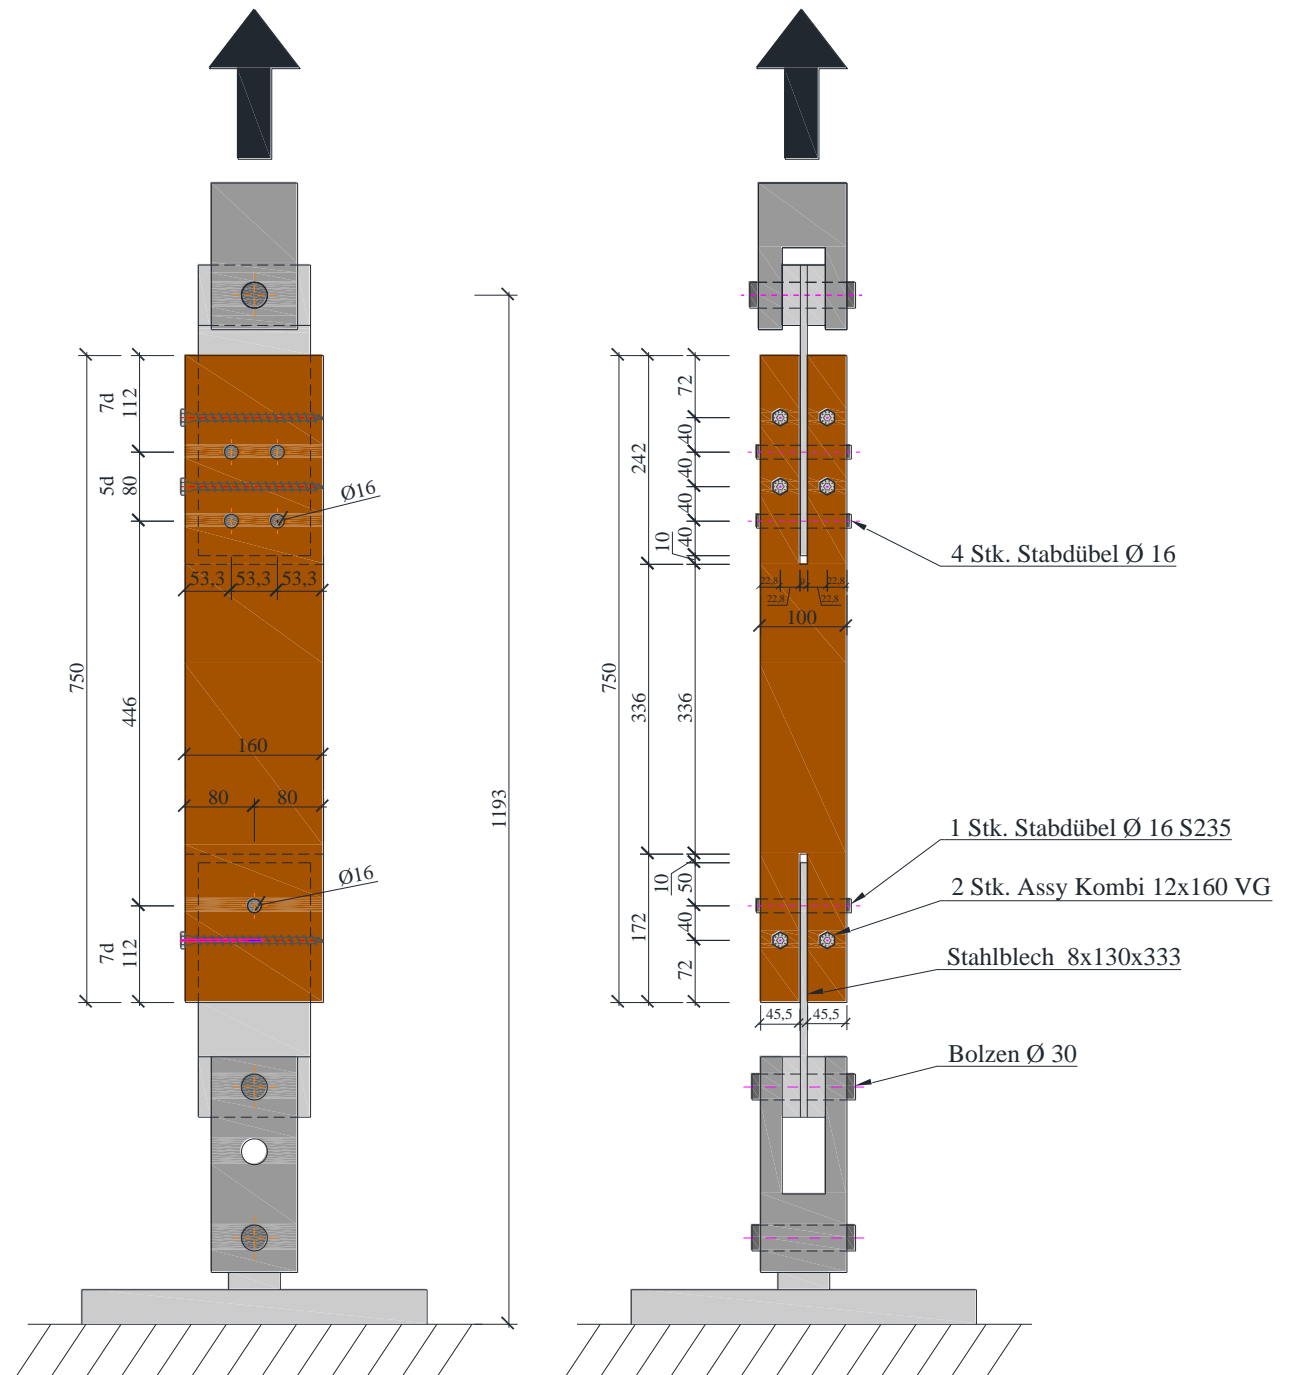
Prüfkfiguration der Prüfsérie ST16-ST-n1-m1 (Abmessungen in mm)
